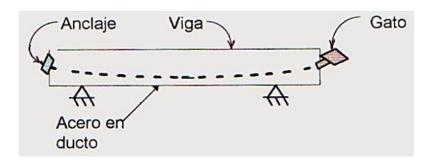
Concreto pre esforzado postensado (Navarro, 2008)
